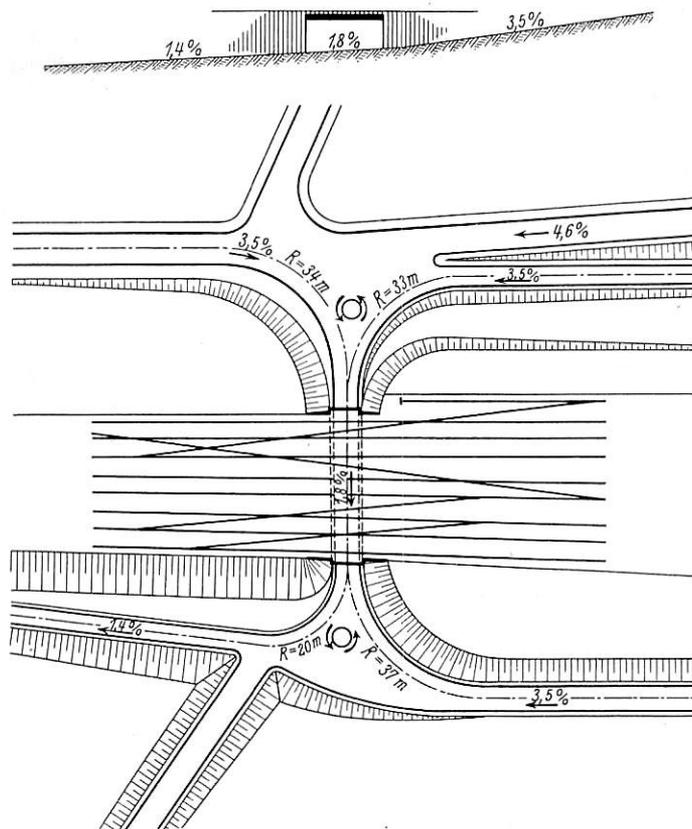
Unterführung der Straße Stuttgart-Mühlacker unter Bahnhof Zuffenhausen.
